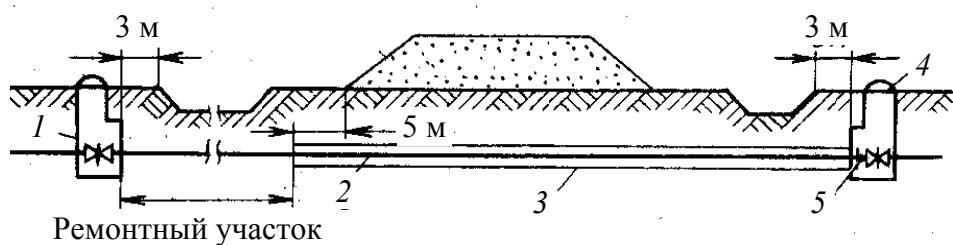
Схема перехода под железнодорожными путями: 1, 4 – соответственно колодцы с задвижками на входе и выходе трубопровода; 2 – стальной трубопровод (рабочая труба); 3 – стальной кожух (труба большого диаметра); 5 – выпуск
